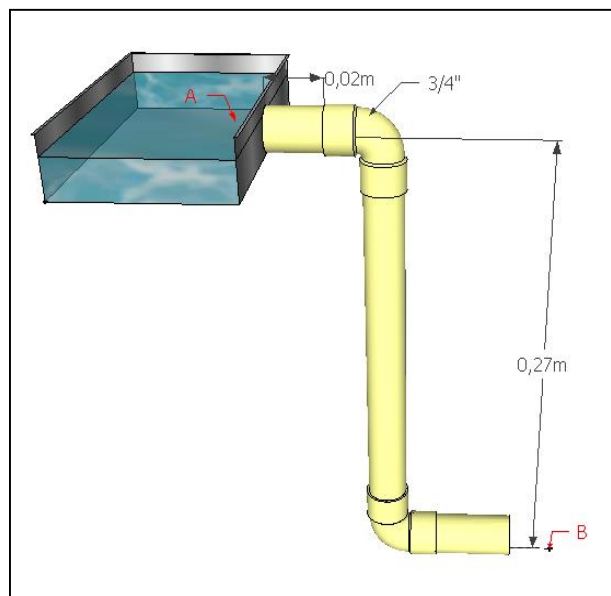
Sistema de drenaje 1 diámetro 3/4".
